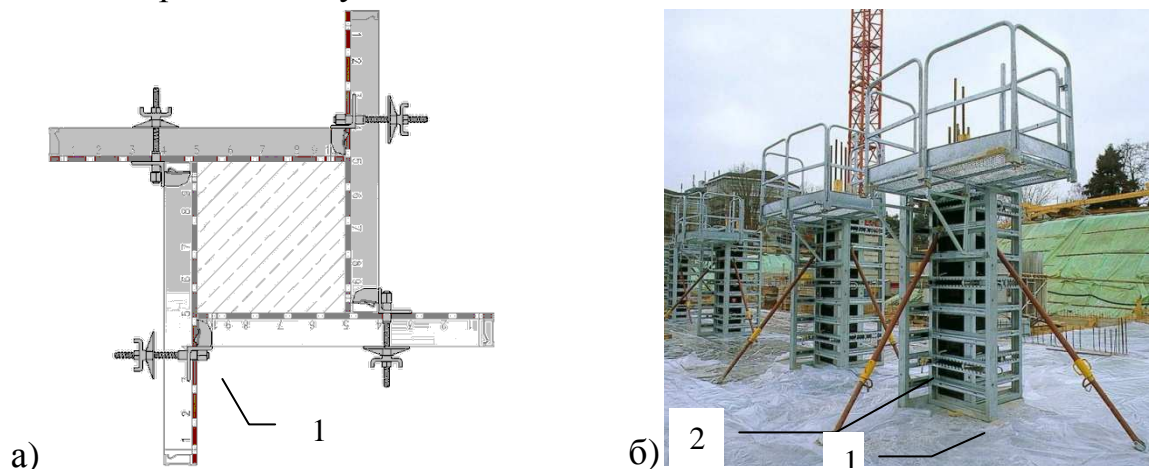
Опалубка колон фірми «НОЕ»:
